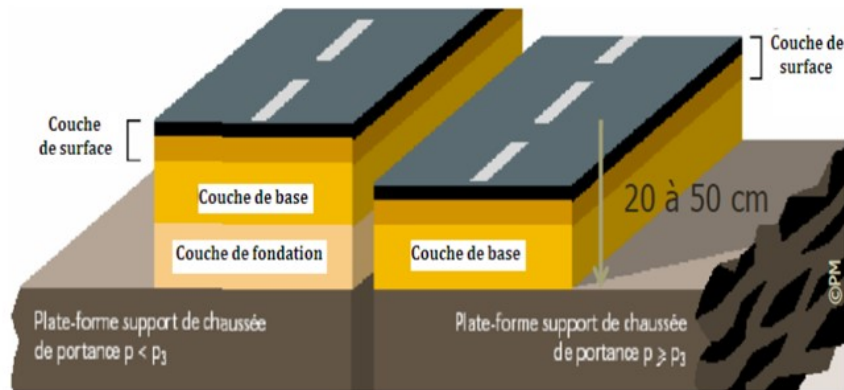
Structure type d'une chaussée semi-rigide.
